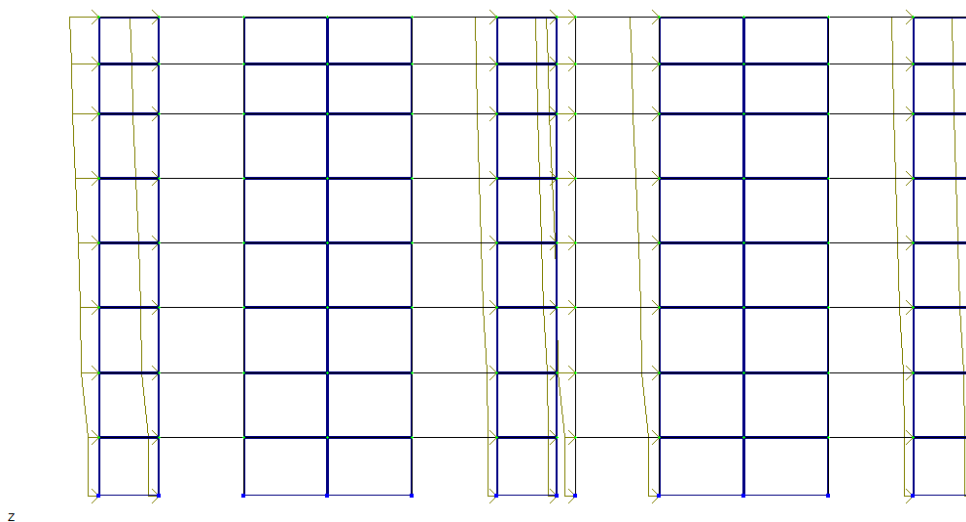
Схема вітрового навантаження на продольну раму, вітер з ліва
